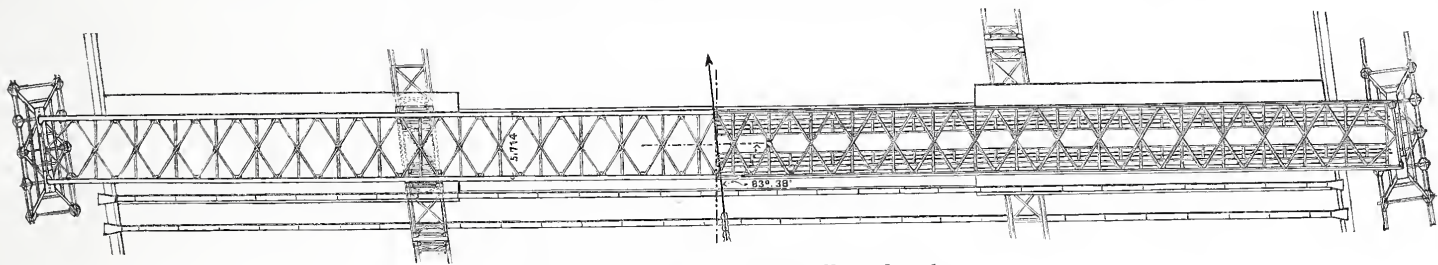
Grundriss der Aufstellungsbrücke.
